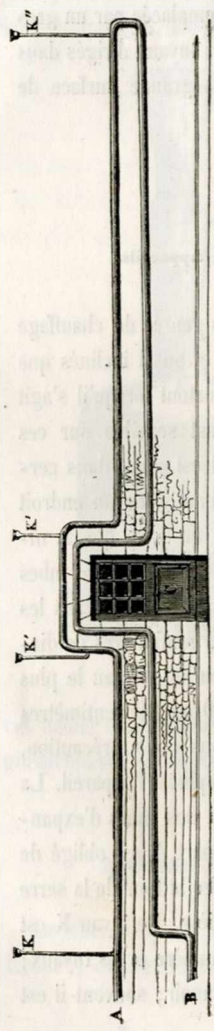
Passage des tuyaux du thermosiphon au-dessus d'une porte, et placement des tubes d'expansion.
